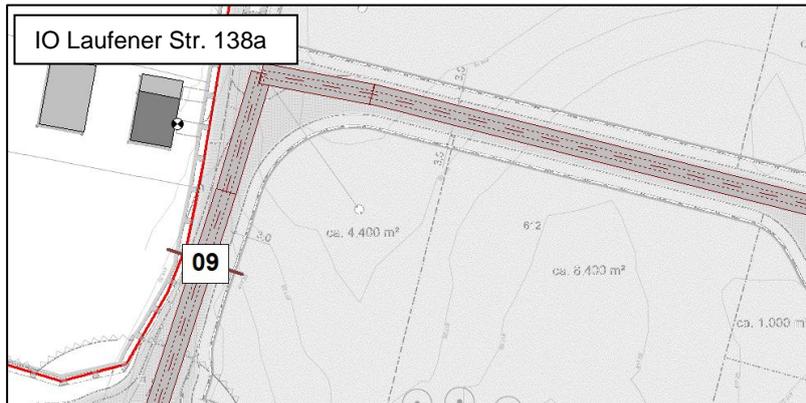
Gewerbestraße und Wohngebäude Laufener Str. 138a
